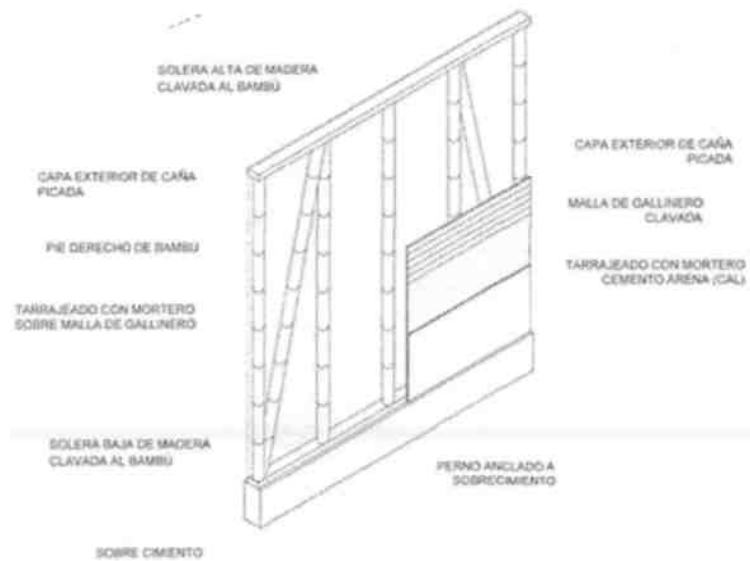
Entramado y recubrimientos del muro de barro a re que en cementado o (Ministerio de la vivienda, construcción y saneamiento del Perú, 2012)
